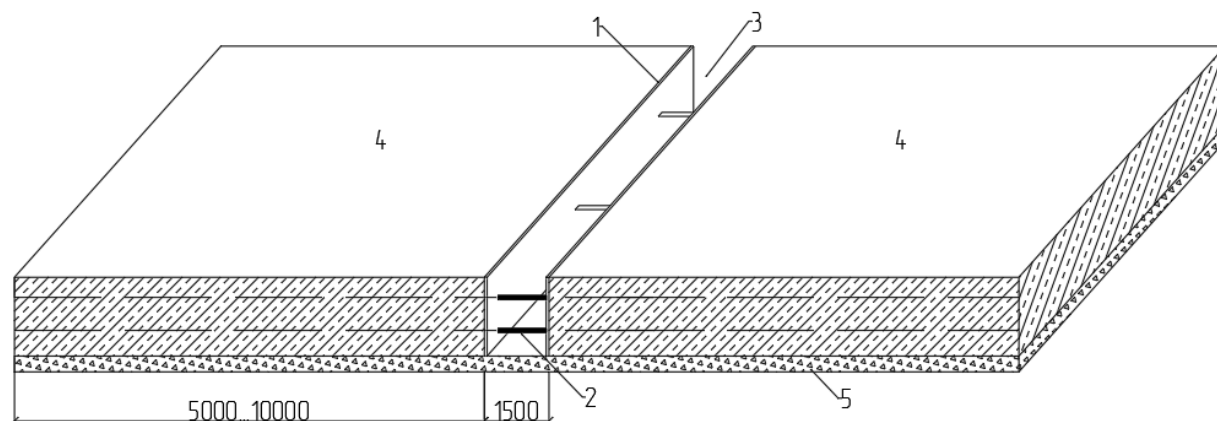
Схема укладки бетонной смеси в фундаментные плиты
